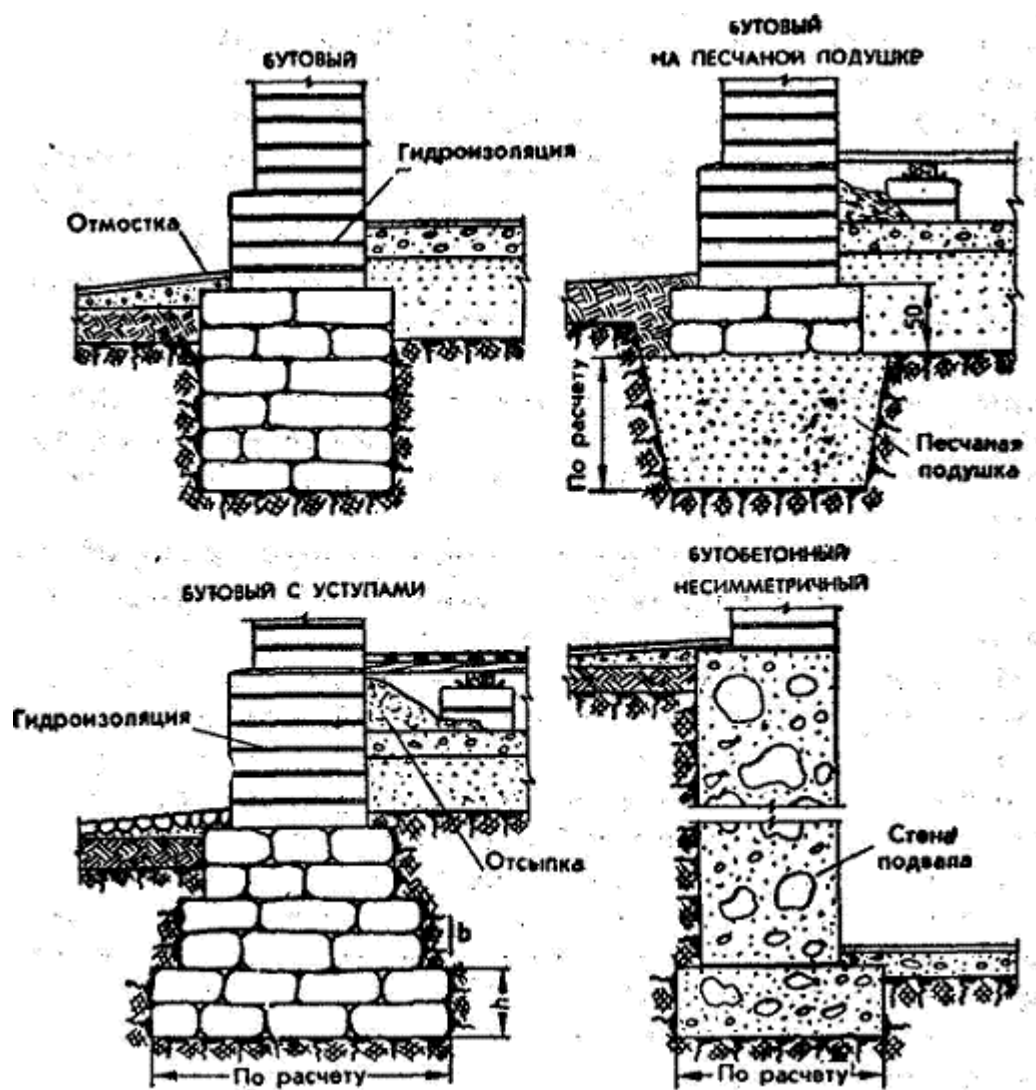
Схем и розташування фундаментів з бута та з монолітного бетону
